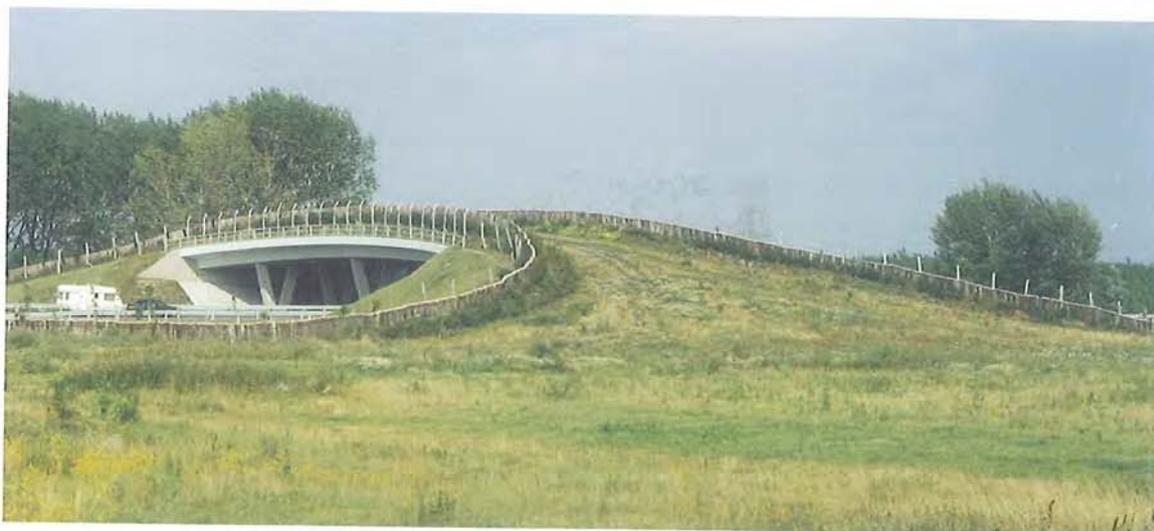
En este paso superior construido en Hungría, la autovía discurre por un terreno llano y por ello se construyeron rampas de acceso para conectar el paso elevado con los alrededores. Las vallas guían a los animales desde los márgenes de la carretera hasta la entrada del paso. (Foto de P. Farkas)
